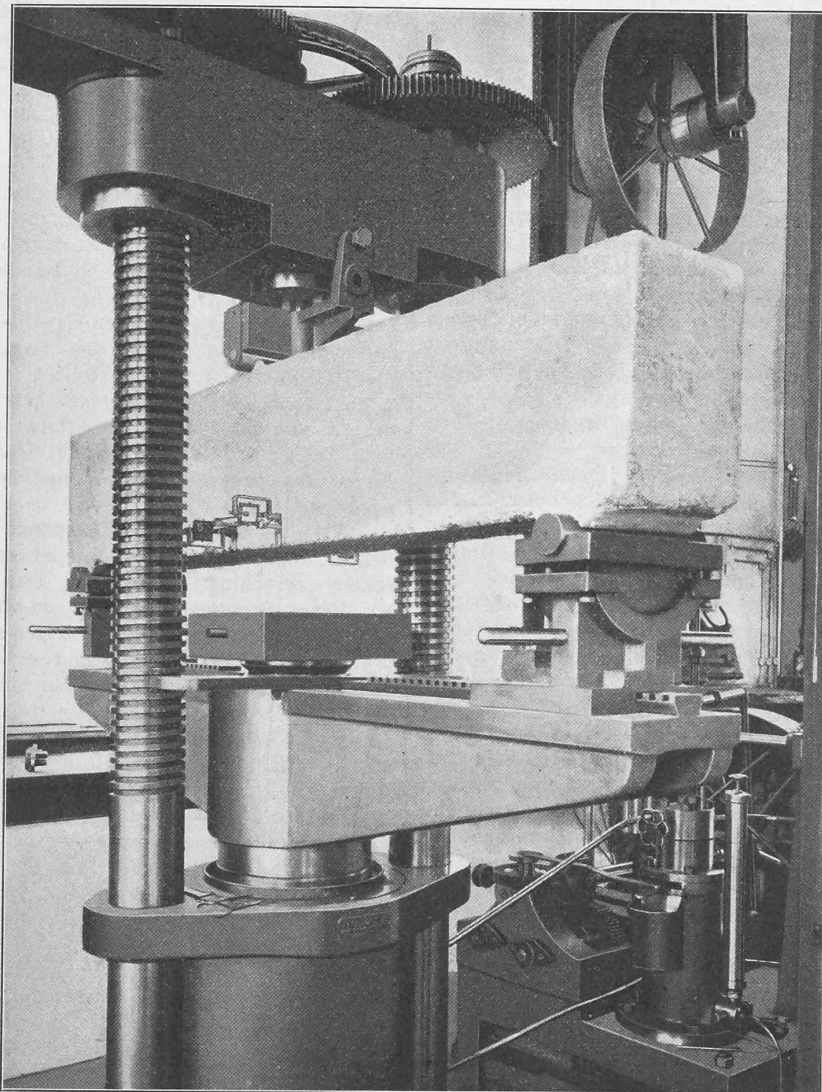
Disposition des poutres B et C pour l'essai à la flexion sur la presse Amsler.
